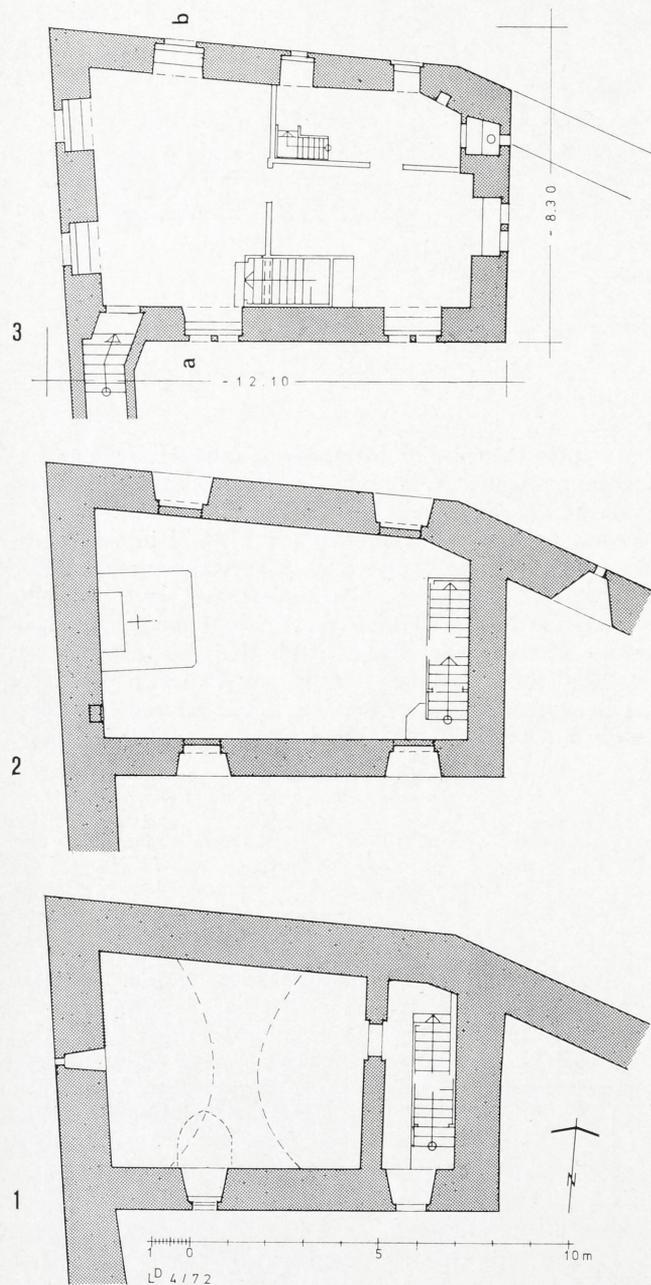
Waldburg bei Ravensburg. Grundrisse des Kapellenbaues. (Zeichnung des Verfassers nach Bauaufnahme der TH Stuttgart von 1940)
